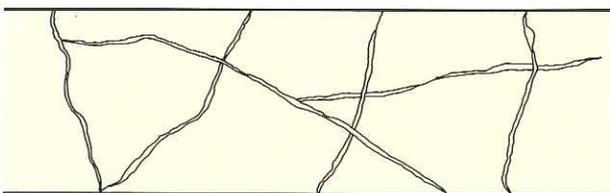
Schéma du comportement des revêtements en béton exécutés sans joints et sans armatures. Fissuration aléatoire, anarchique et grossière.
